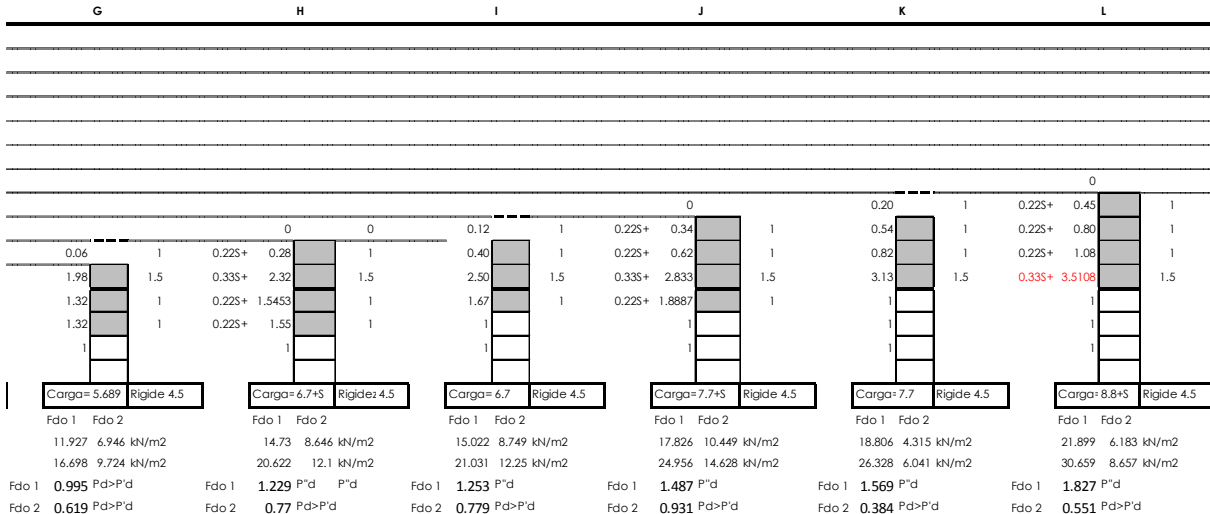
Proceso Constructivo. \$ cimbras 3 forjados de sacrificio. Losa Maciza. 2/5
